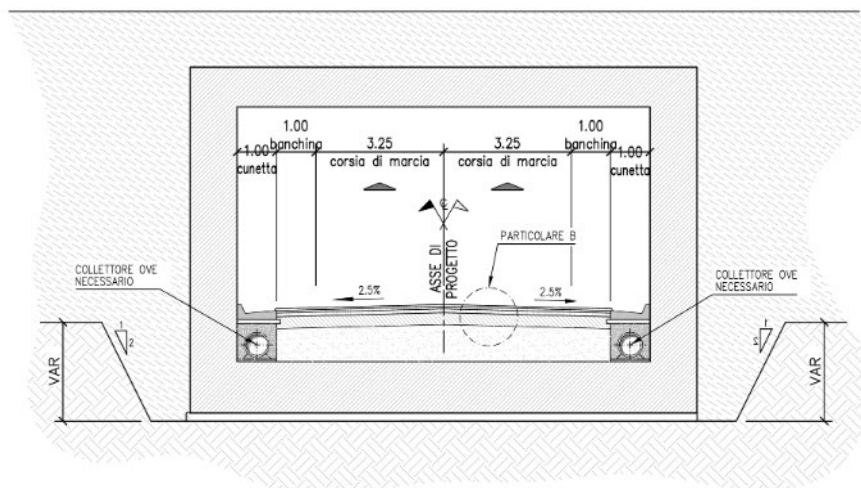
Sezione tipo in sottovia asse secondario – Strada di Accesso alla Dorsale Consortile CASIC
